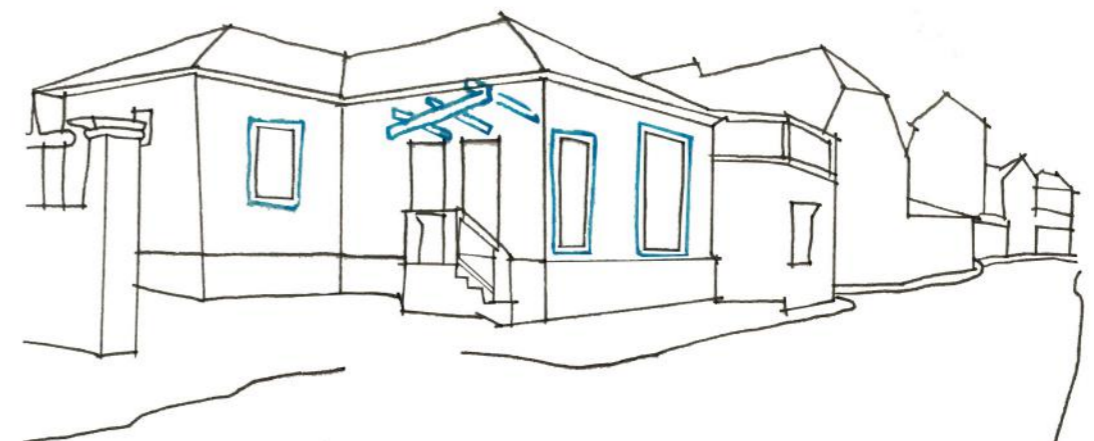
Intervenção da colocação de treliça de madeira na entrada deste edifício como uma característica decorativa das fachadas dos edifícios.
